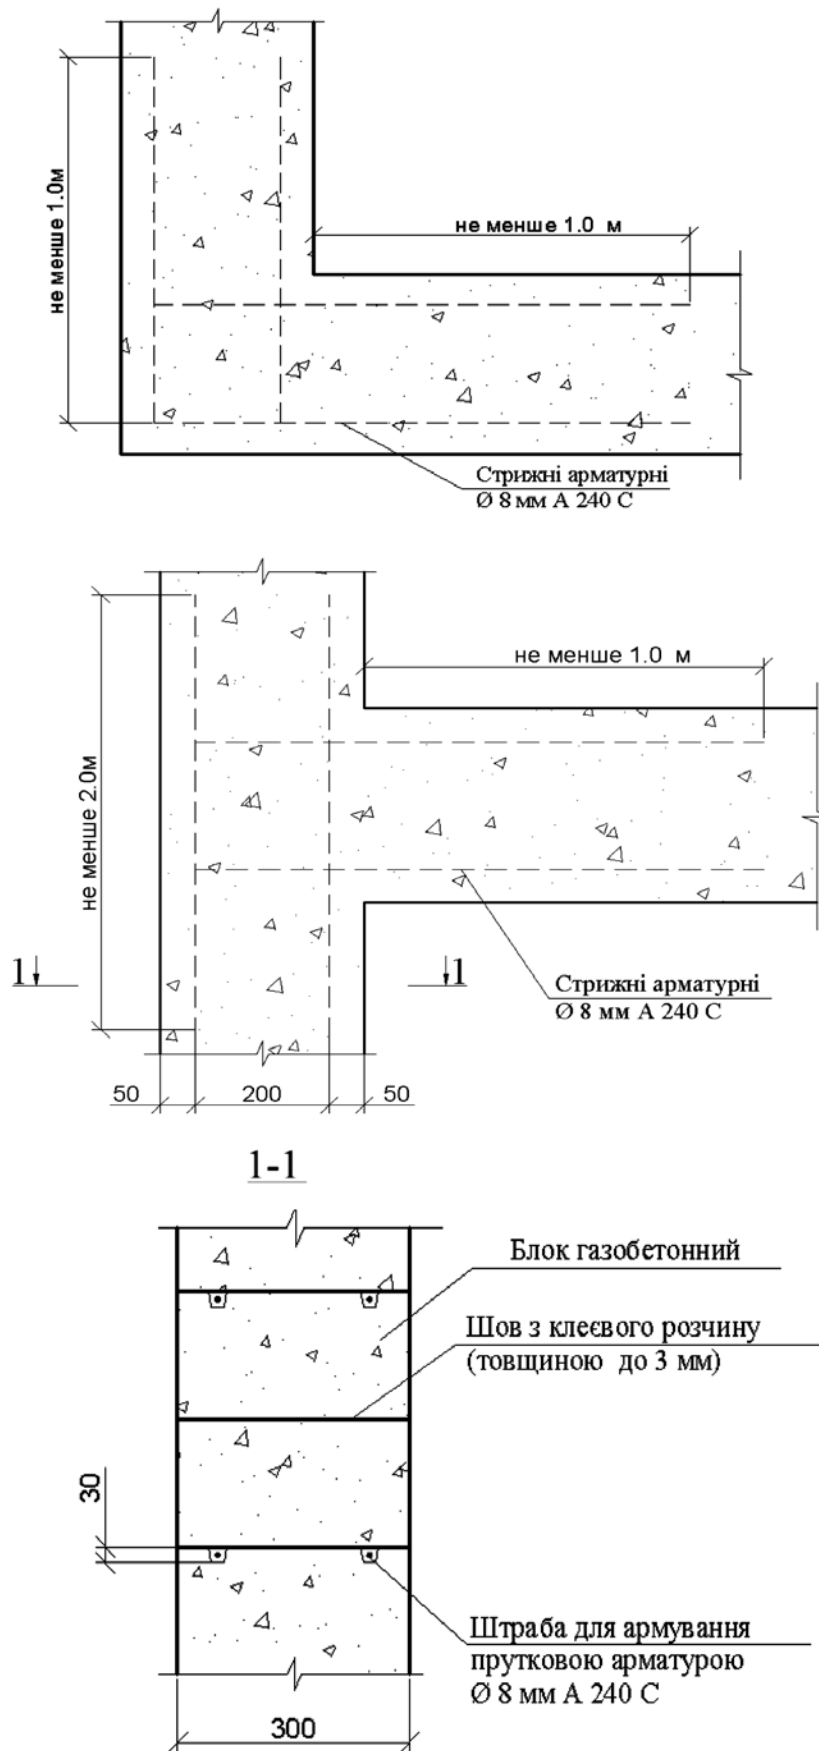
Армуння кладки стін із газобетонних блоків прутковою арматурою
